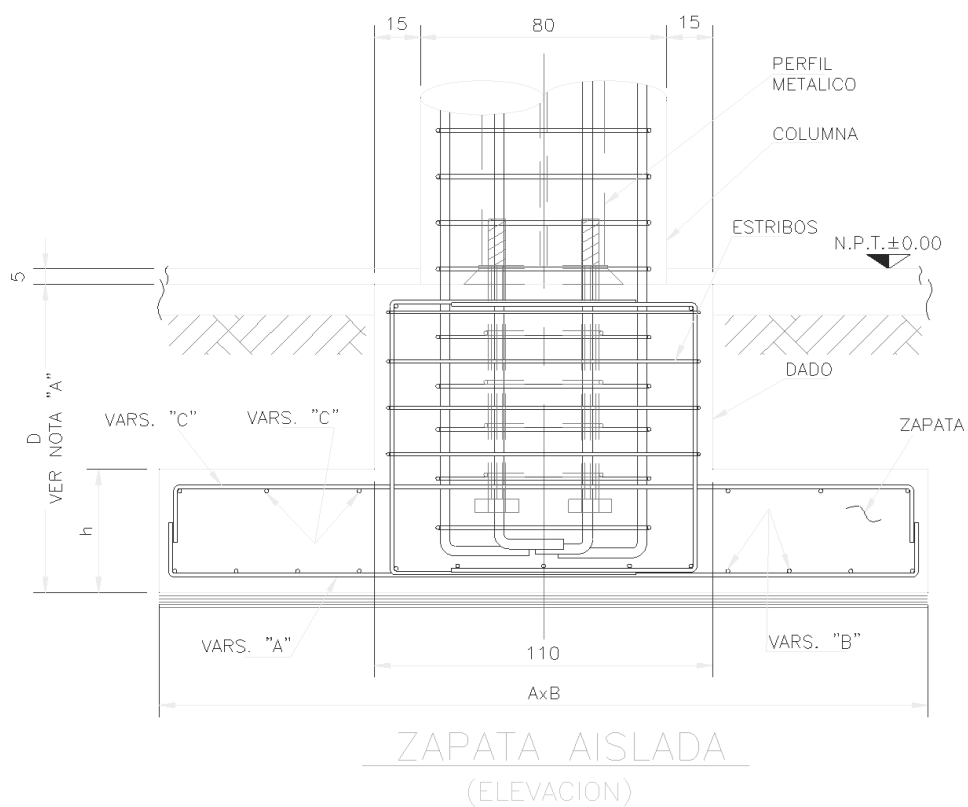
Corte esquemático de las zapatas aisladas.
